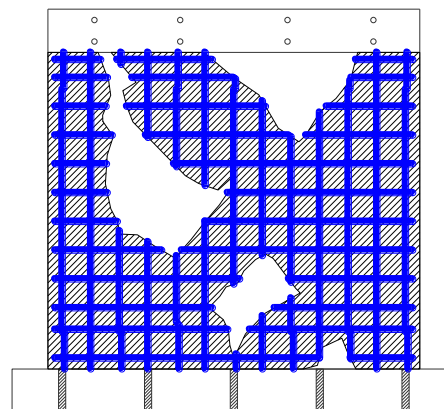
Agrietamiento de muro de albañilería confinada con ladrillos sólido artesanal en la distorsión 1/800.
